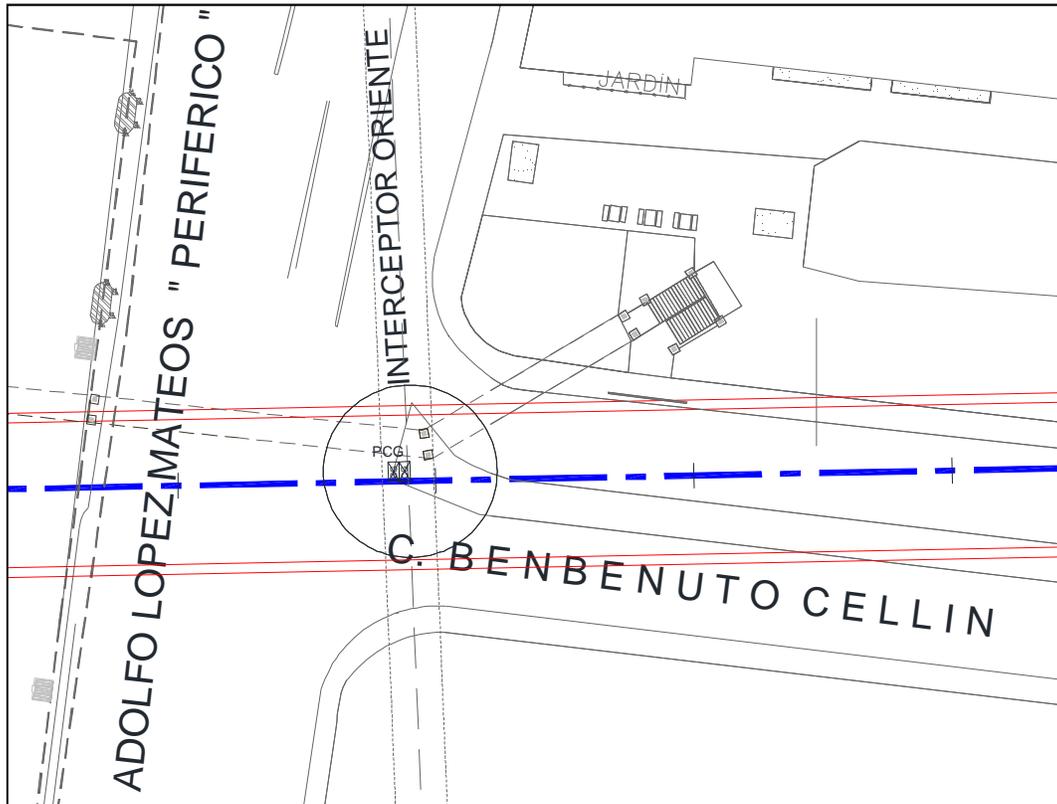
Vista en planta de Piezómetro tipo Casagrande.
